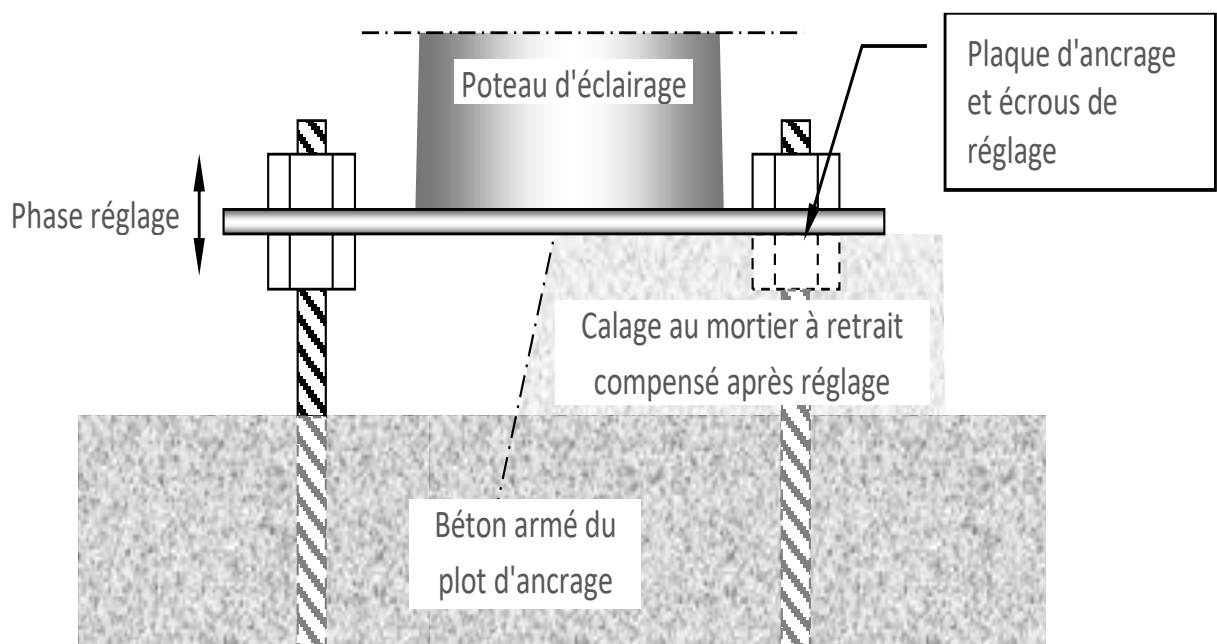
Principe de fixation et réglage des poteaux d'éclairage
